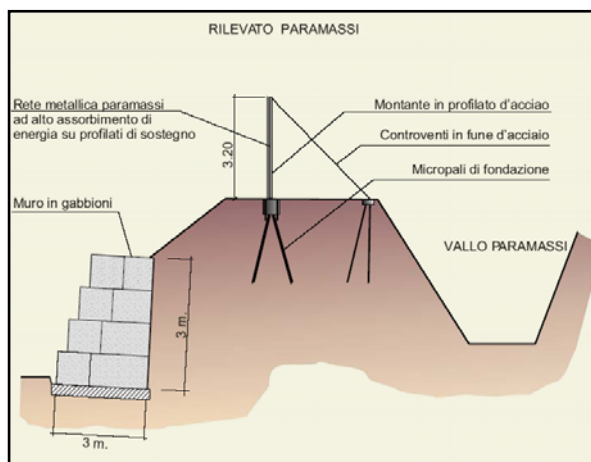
Sezione tipo di “vallo e rilevato paramassi”. Il fondo dello scavo deve essere rivestito da materiale granulare assorbente per uno spessore generalmente non superiore ad 1 m; si può notare il rinforzo della struttura tramite un muro di gabbioni sul lato di valle del rilevato (da ANPA 2002) -
